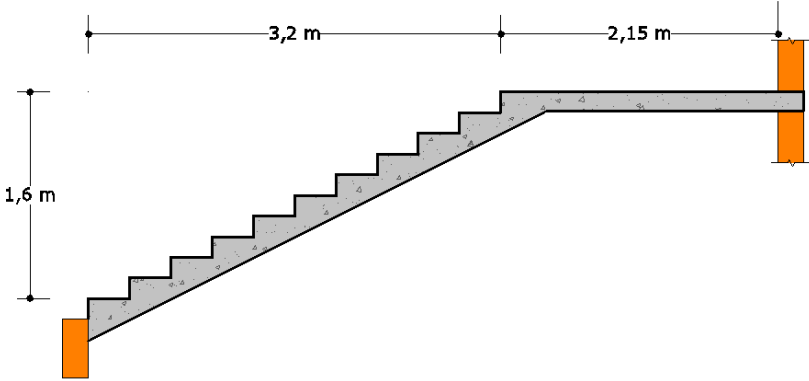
Primer Tramo Escalera; Elaboracion Propia
